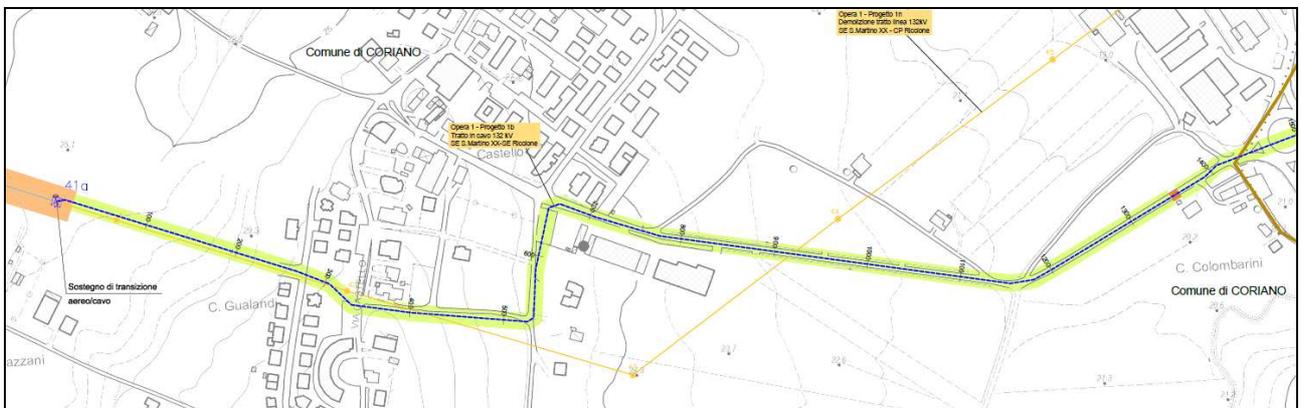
Stralcio Elaborato DGDR11008B753460 – Planimetria con Distanze di Prima Approssimazione (DPA)
